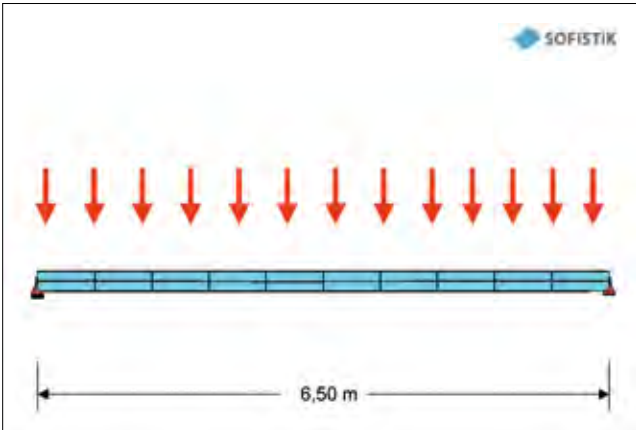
Beanspruchung einer Holzbalkendecke durch eine gleichmäßige Verkehrslast
